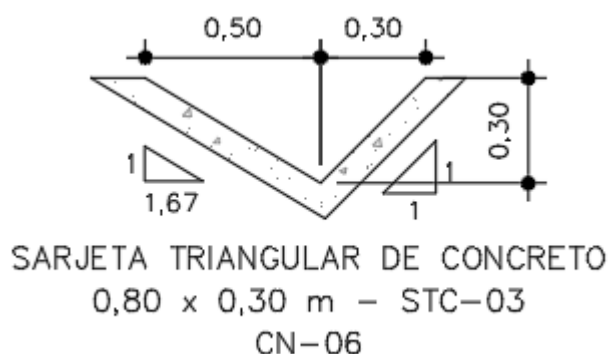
Seção Típica – Sarjeta Triangular de Concreto STC-03
